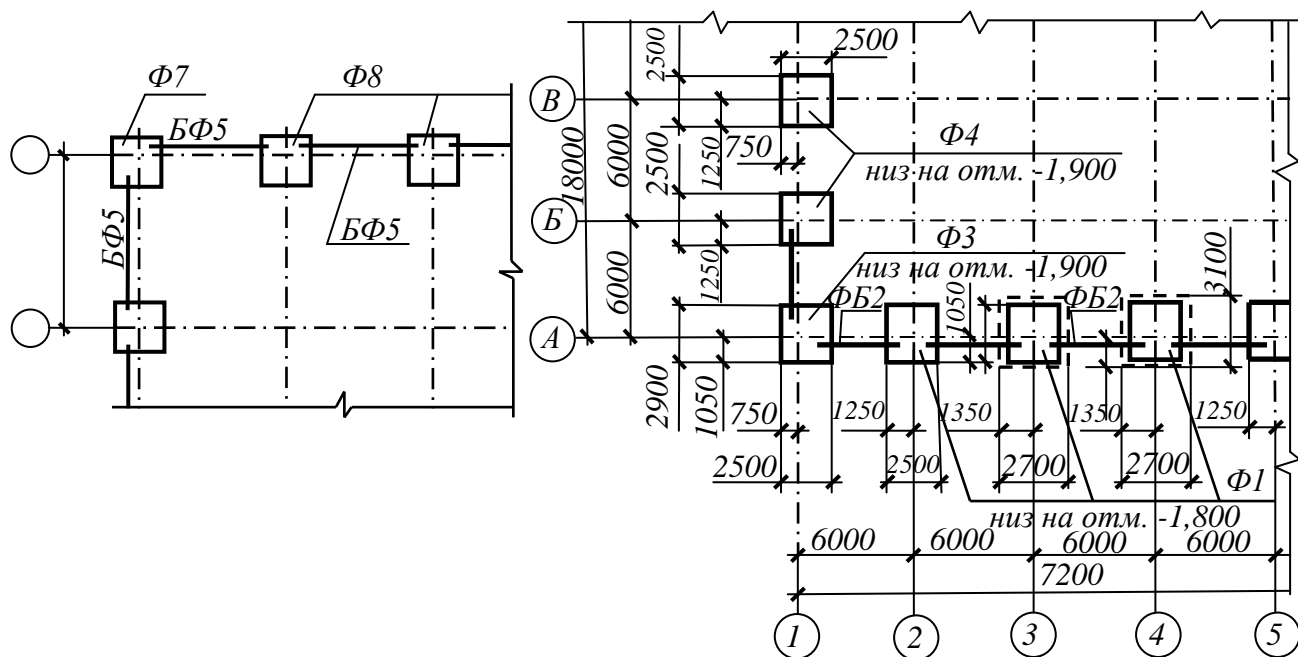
Примеры схем расположения фундаментов и фундаментных балок
